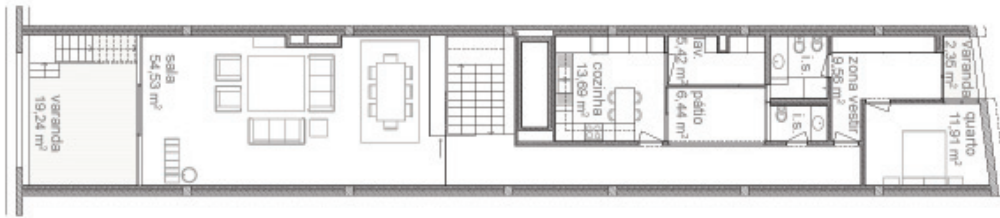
Planta T3 duplex tipo (piso 6) - Corpo principal.
